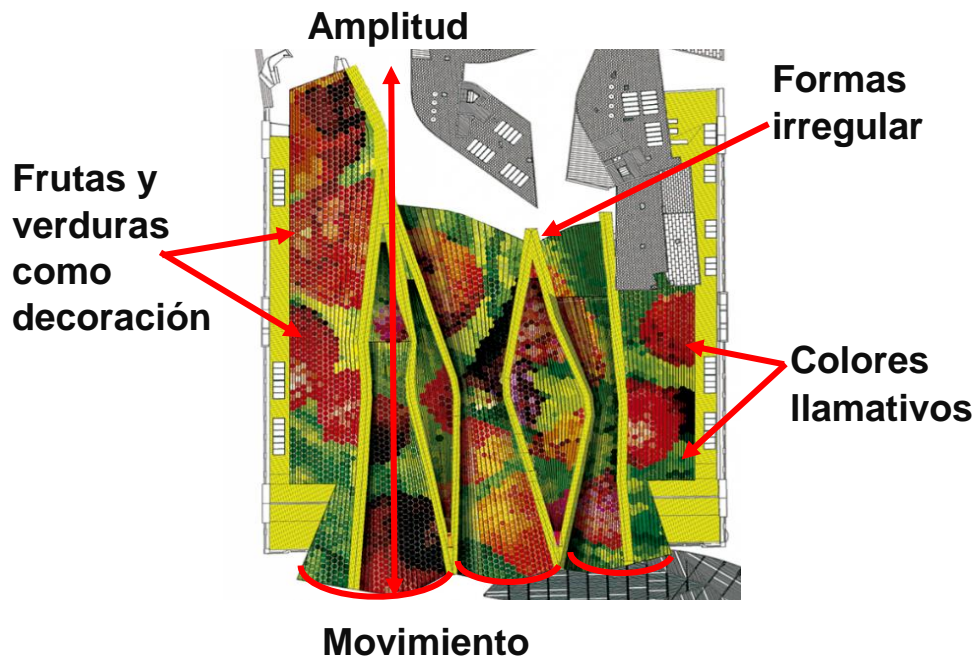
Análisis planta de azotea mercado Santa Caterina
